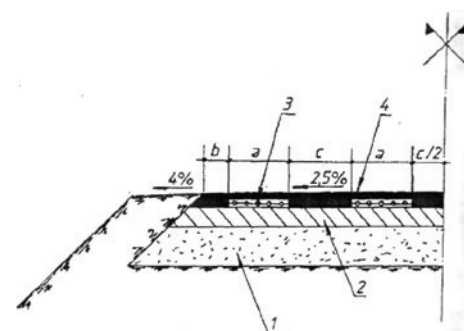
Schemă generală structură rutieră nerigidă cu armare variabilă (Andrei, 1990)
